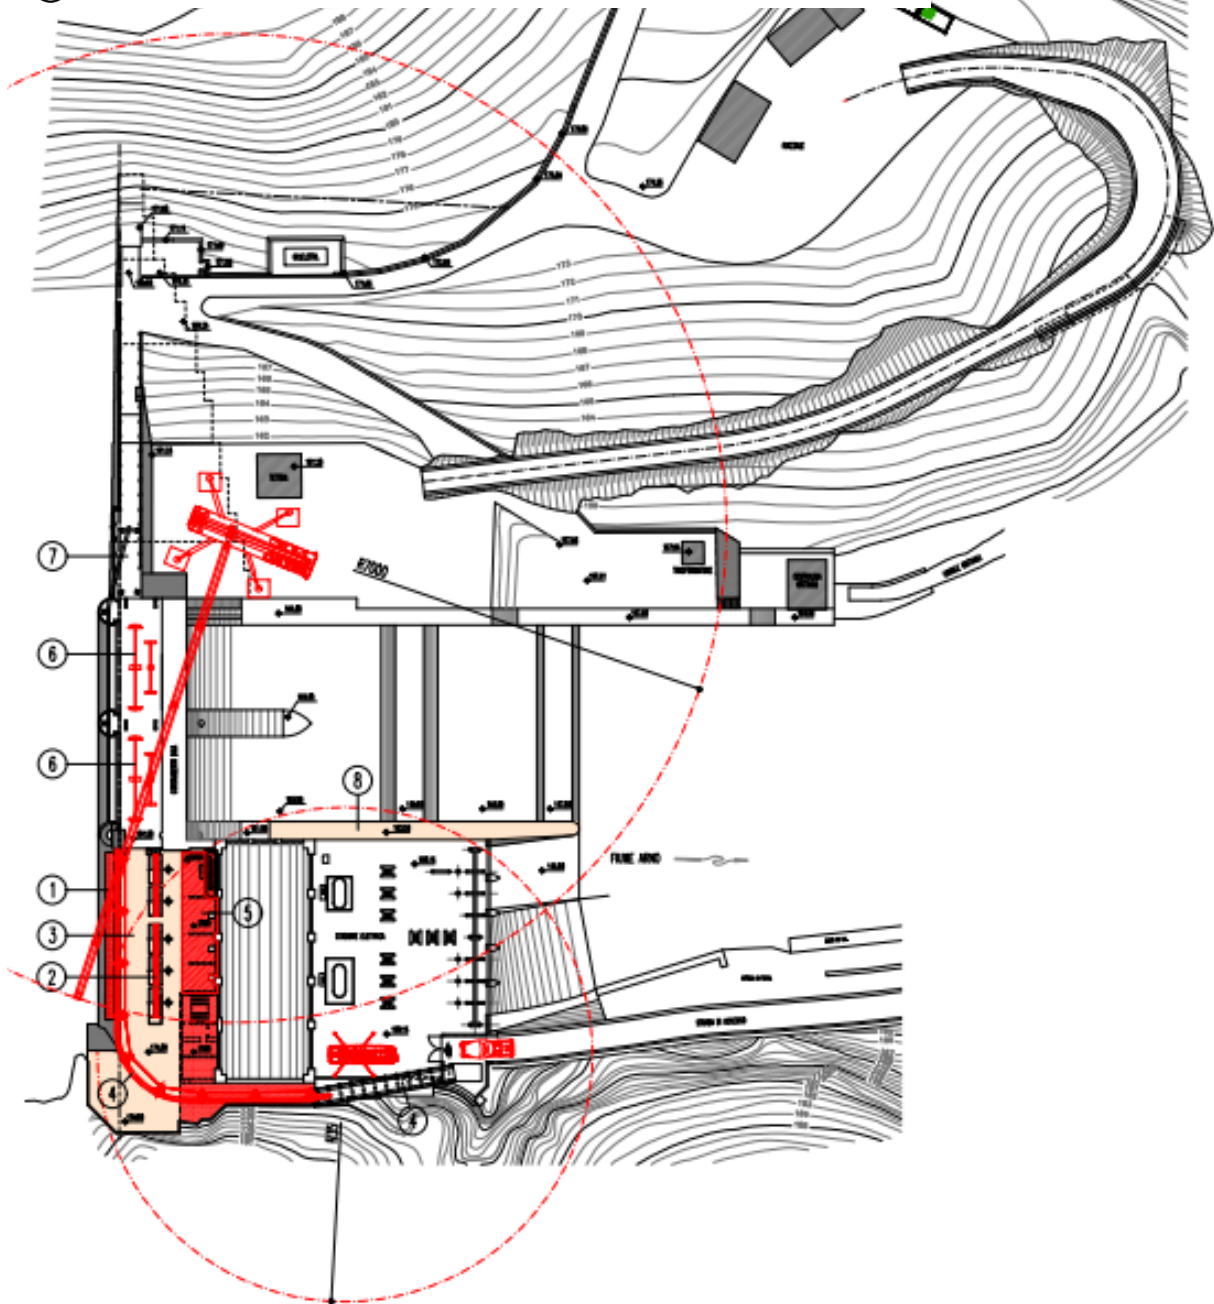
2 – Estratto planimetrico elaborato progettuale – Cantierizzazione FASE2
